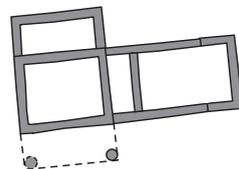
Plan général des vestiges du bâtiment 5 et proposition de phasage de son évolution architecturale (DAO S. Cocquerelle, Inrap).
